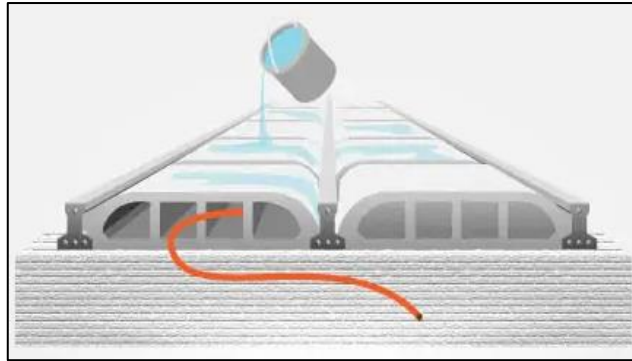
Paso 2: Coloca las viguetas dentro de la dala, trabe, muro o viga. Tomada de «Conoce todos los tipos de viguetas que más se utilizan en construcción», por Acero. 2023, p. 1.
